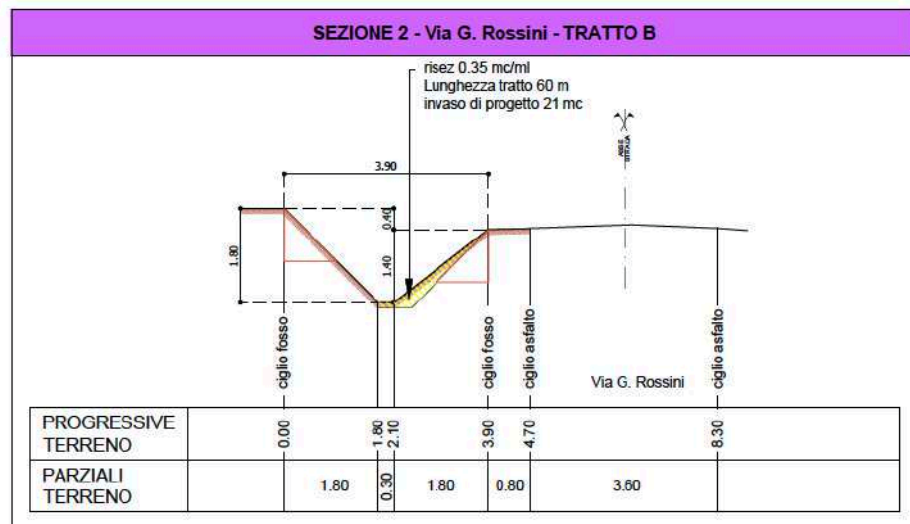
Sezione Tipo lungo via Rossini – Tratto B
